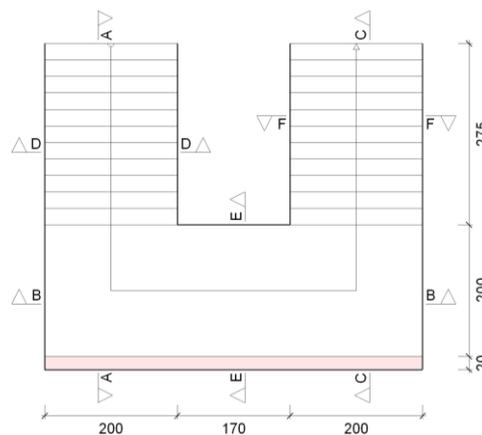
Vista de las dimensiones de la escalera (CypeCad)
